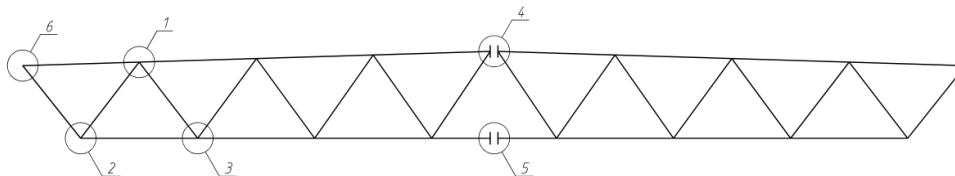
Схема расположения узлов к расчету и конструированию узлов фермы
